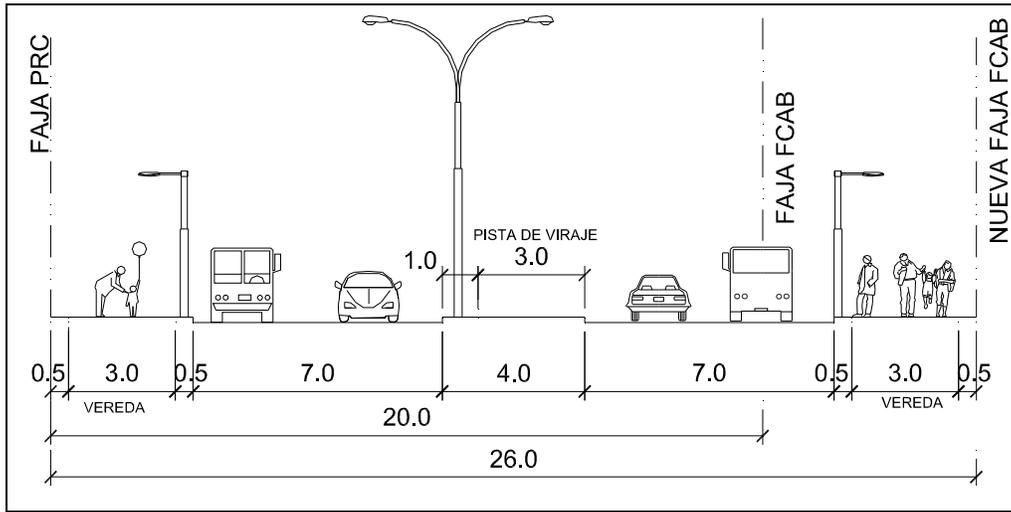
Perfil de 26 m sector central, Puente Loa – Av. Ecuador.
